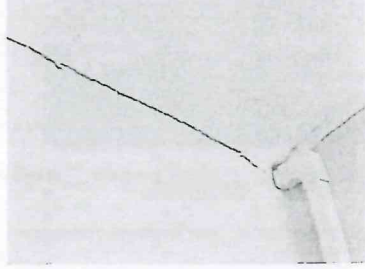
Grietas horizontales entre plafones y los muros.
